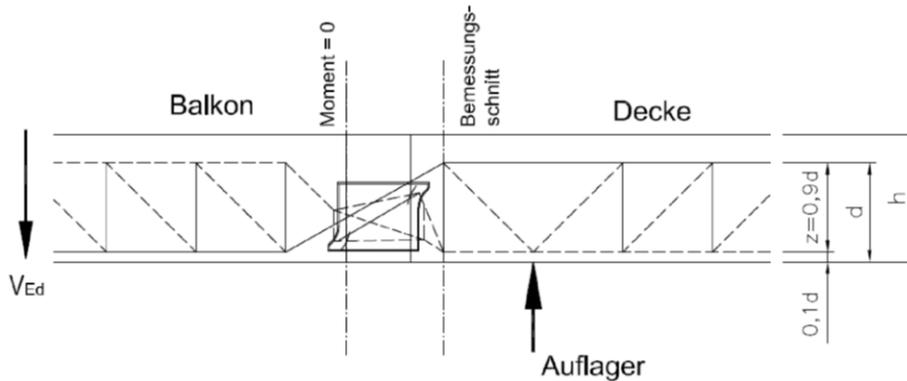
Fachwerkmodell und Bemessungsschnitt HIT-HP/SP ZV mit Druckschublager
